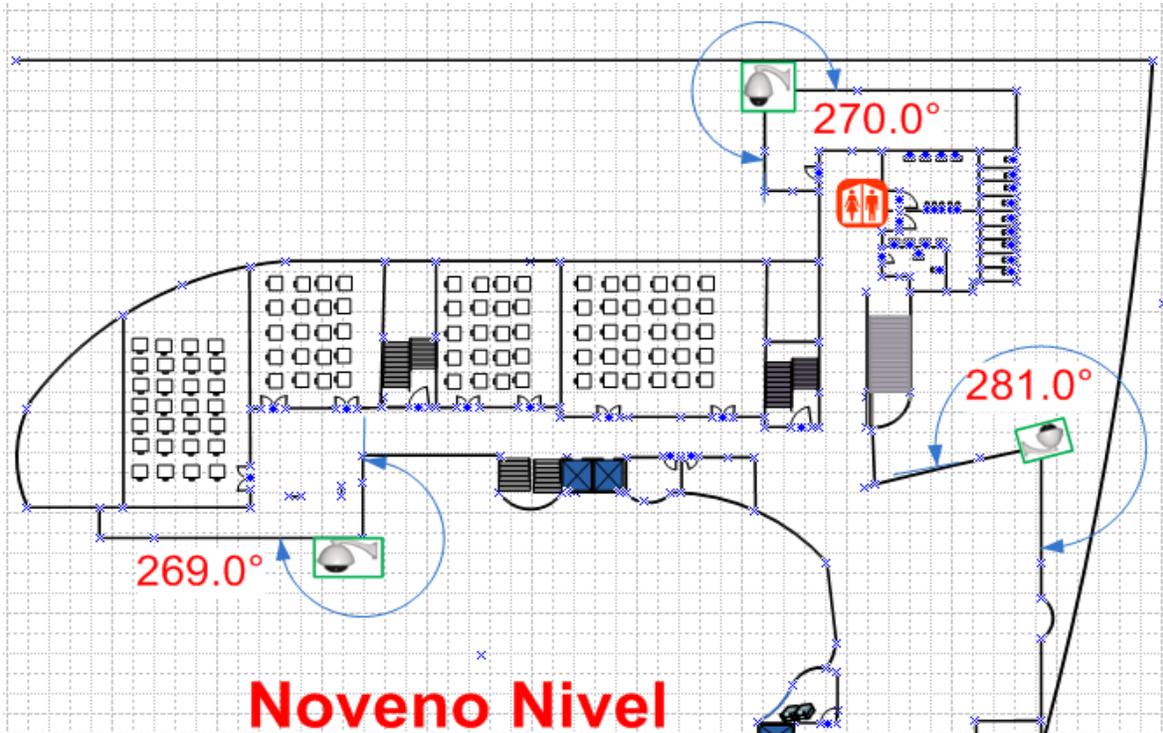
Ubicación de cámaras exterior Noveno nivel pabellón de ingeniería.
